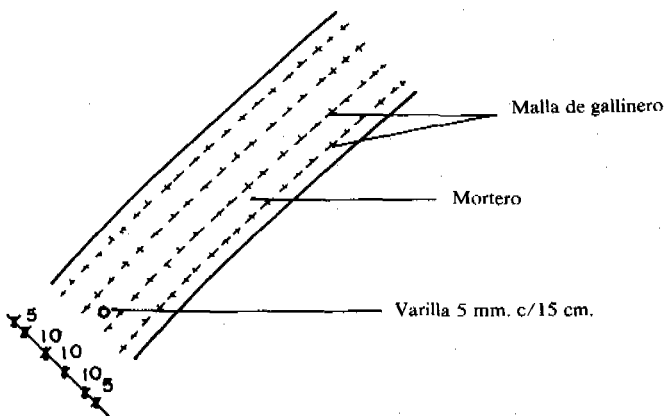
Sección transversal de la pared de un tanque de ferrocemento.
